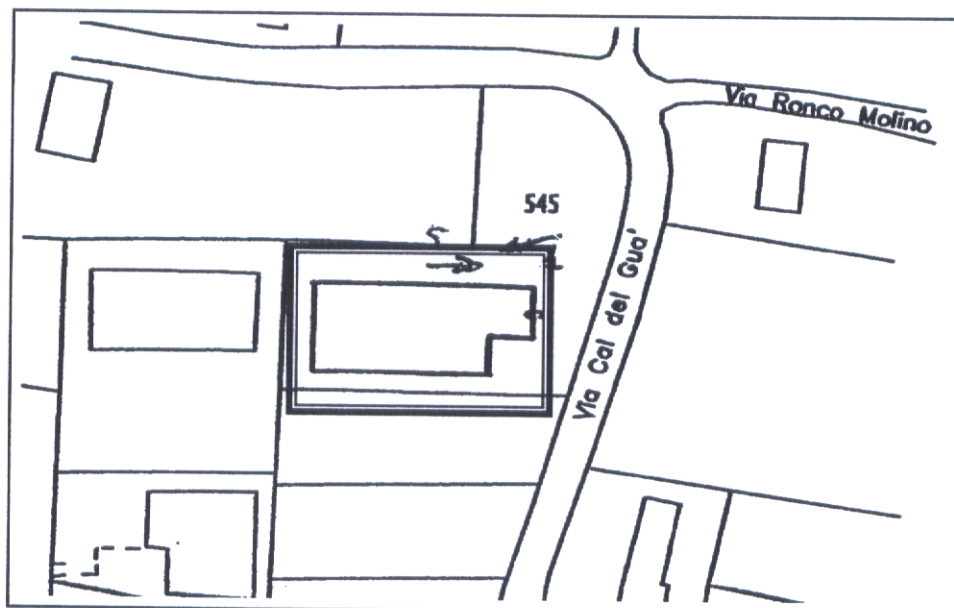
Planimetria dell'edificio in esame (scala 1:2.000).
